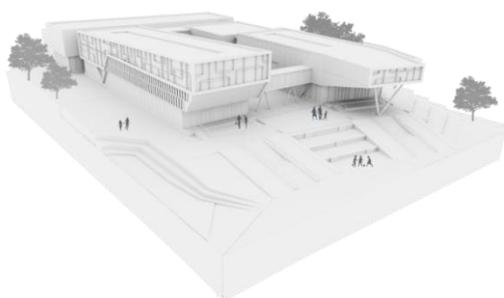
Террасирование и устройство площадок с пандусами (ракурс №1)
